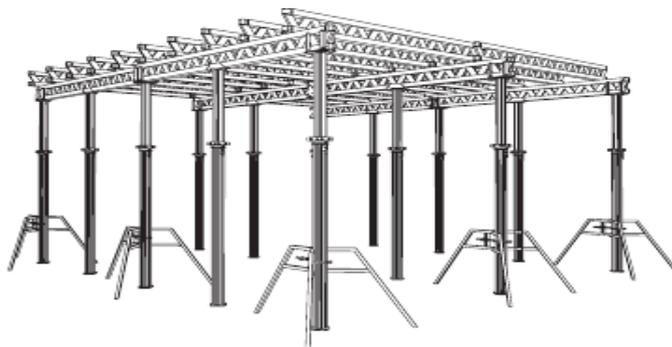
Бетонирование перекрытий с применением балочной опалубки перекрытий «PERIMultiflex»
